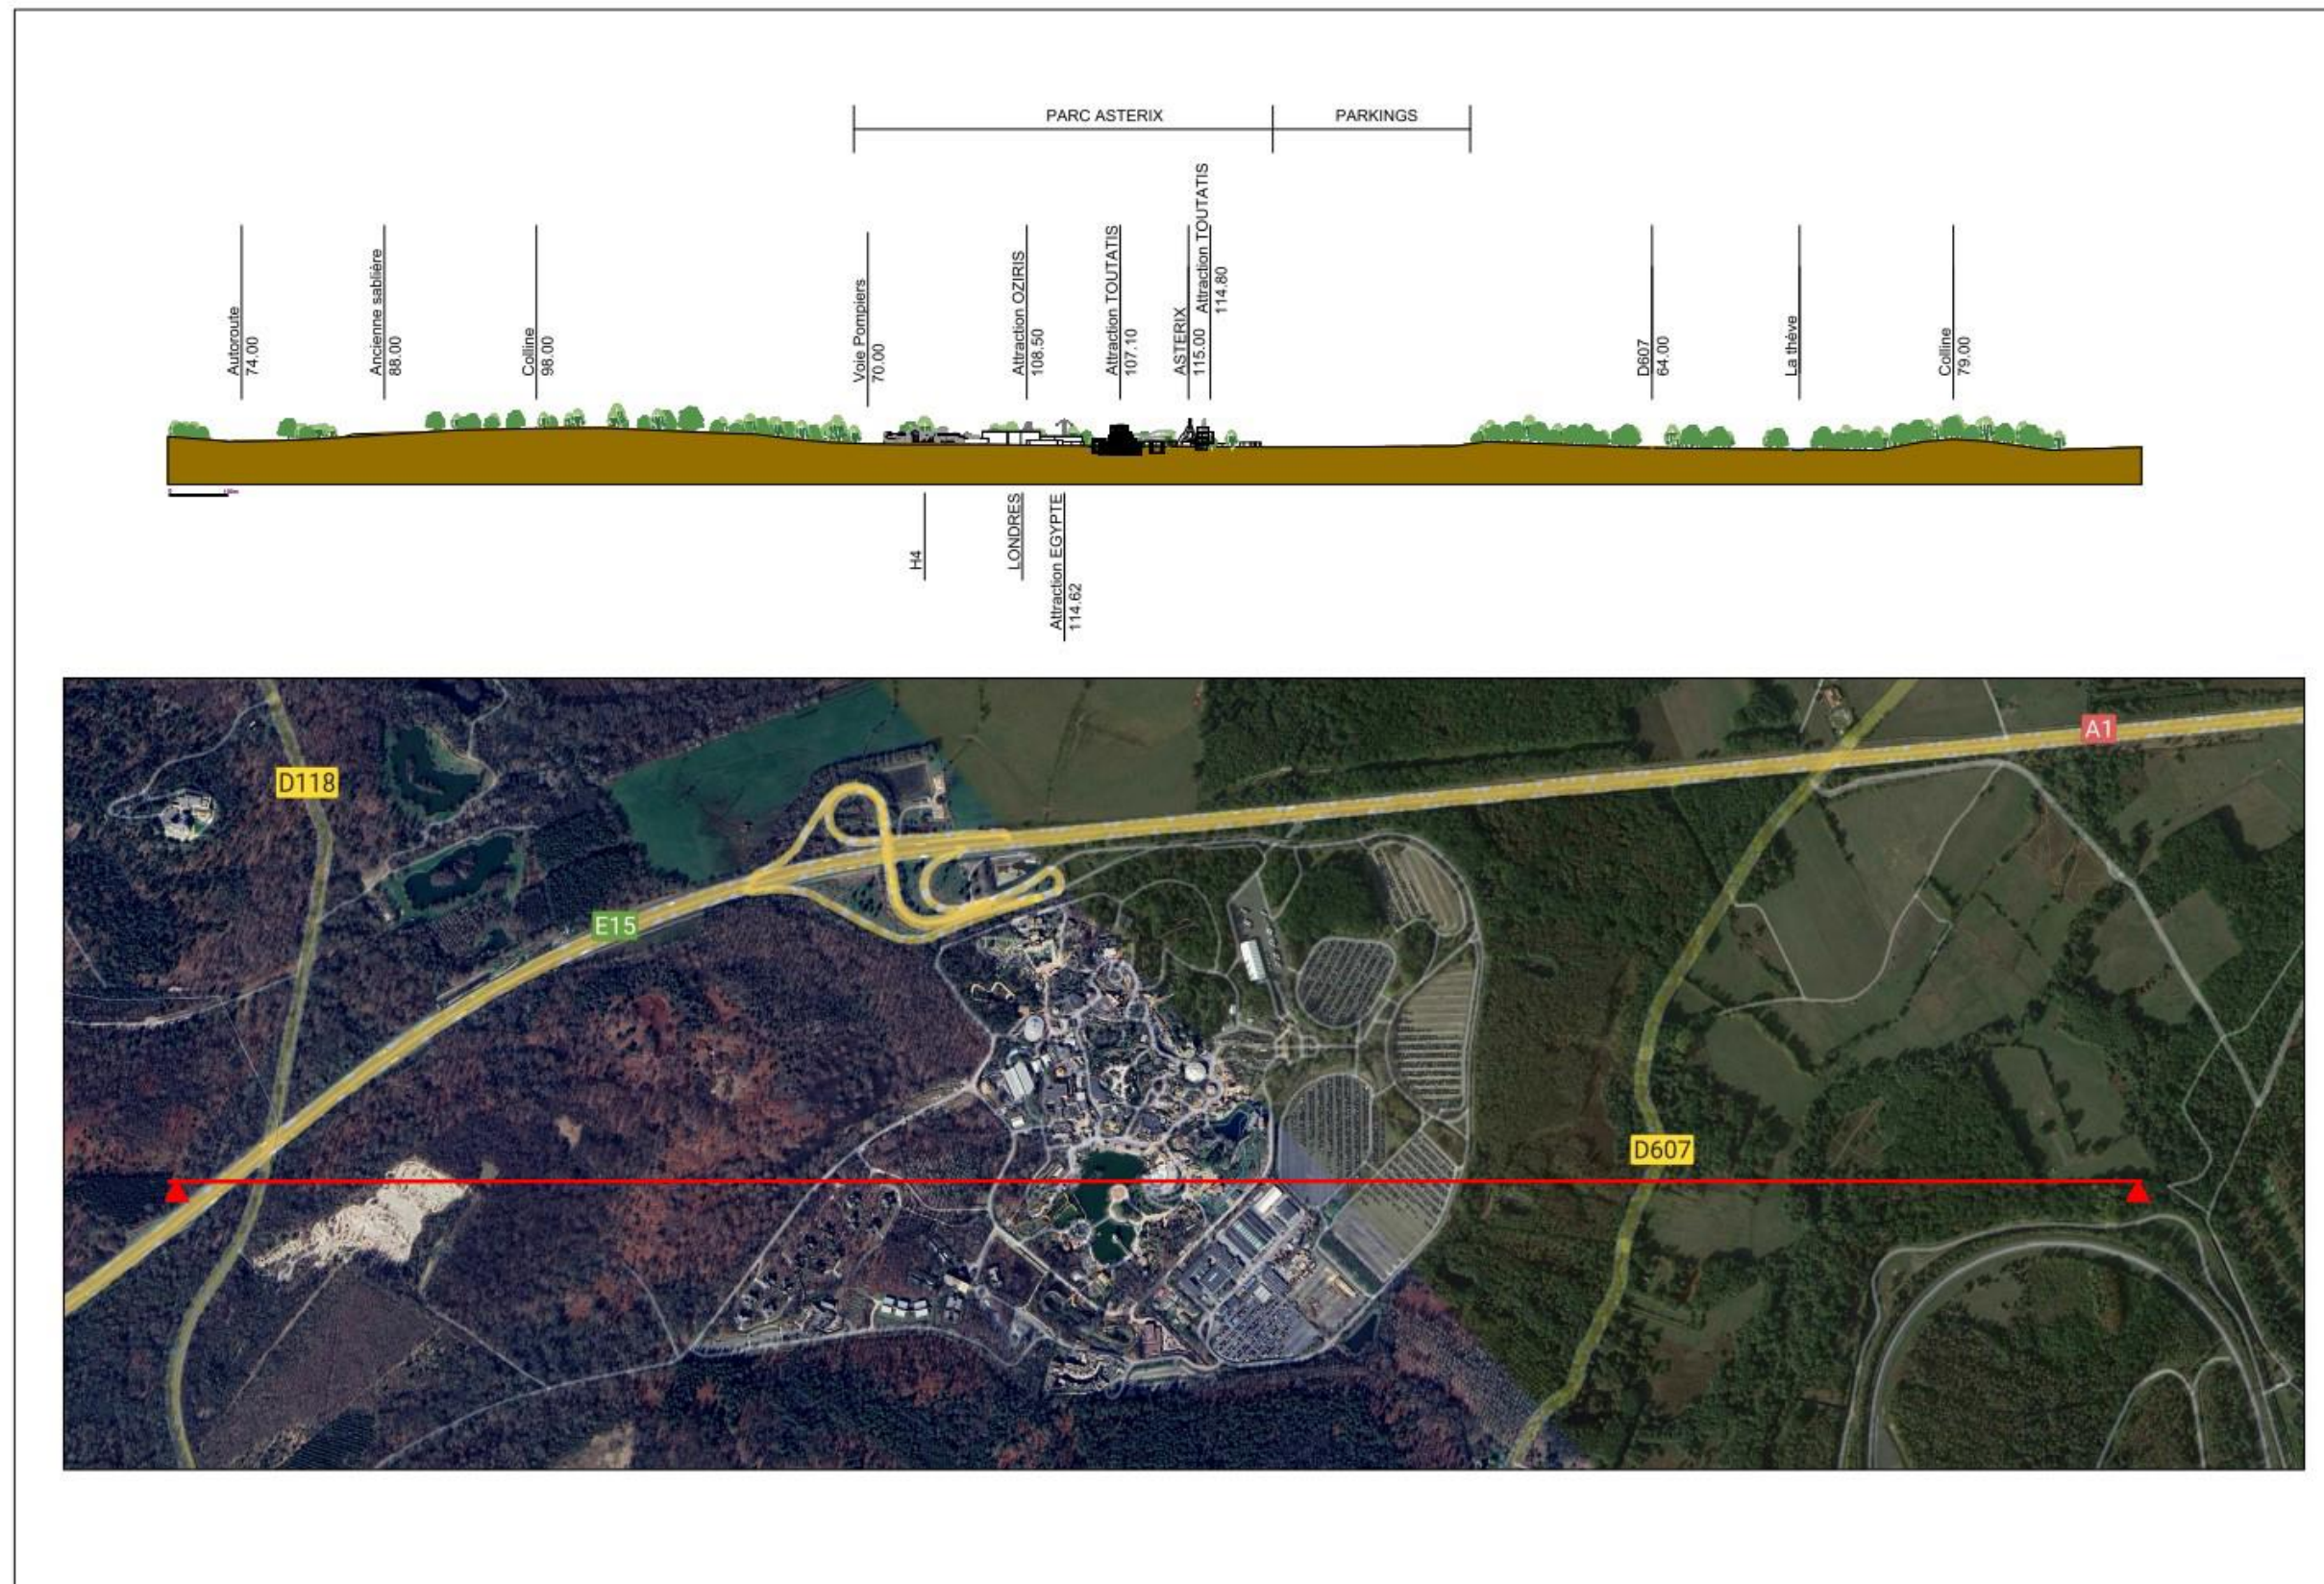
Coupe lointaine nord-sud, orientée vers l'ouest (Parc Astérix)
